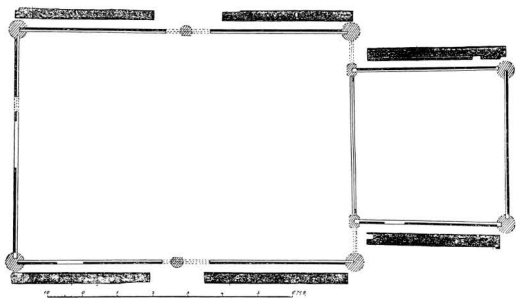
Vänga stavkyrka, rekonstruktion av planen. Efter E Ekhoﬀ.
